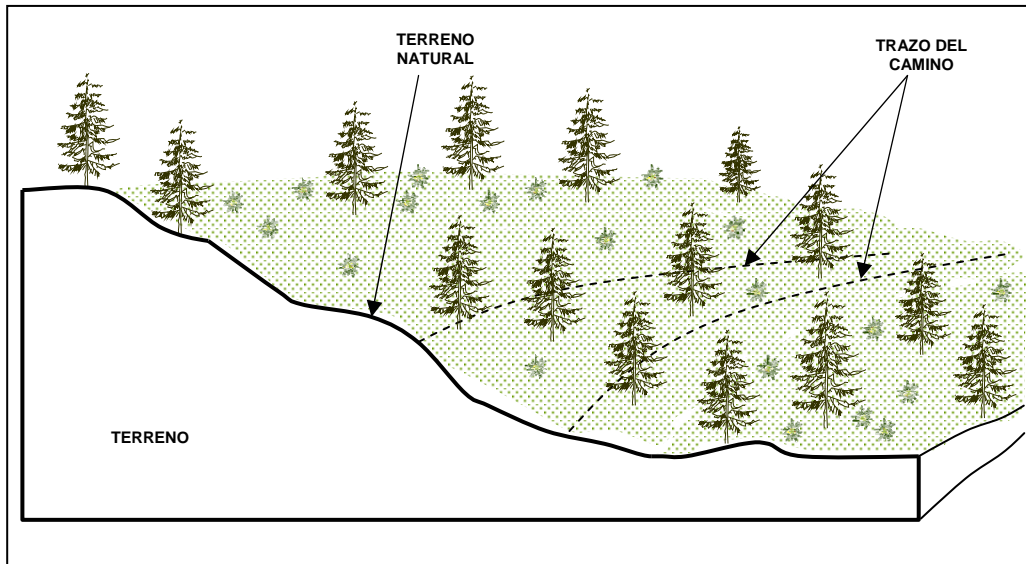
TRAZO DEL CAMINO SOBRE EL TERRENO NATURAL PARA POSTERIORMENTE HACER CORTES Y CONSTRUIR TERRAPLENES
